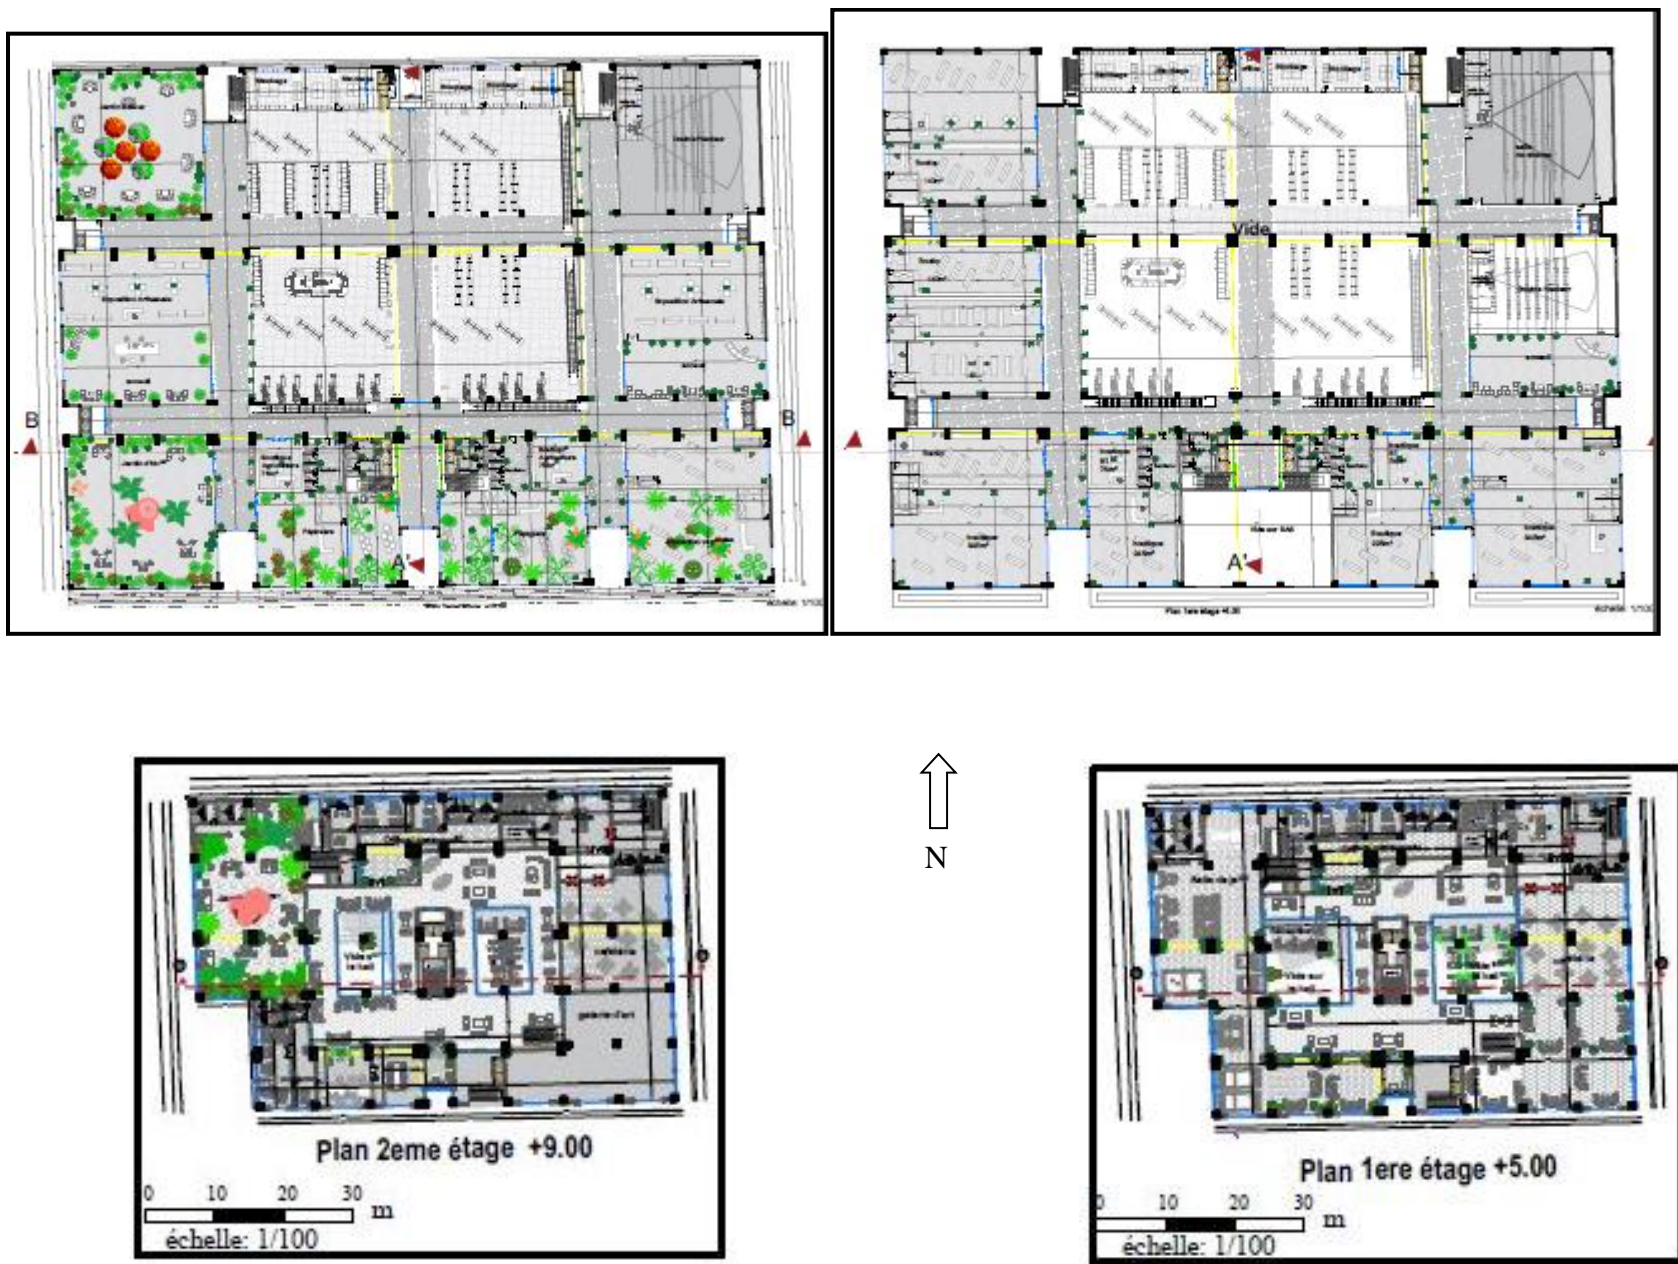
Plan 2eme étage+9.00/ Source : Traiter par l'auteur.
